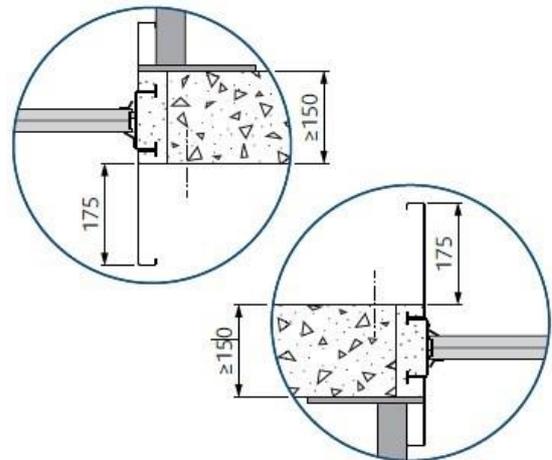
(EI120S) Sezione trasversale di ① Installazione umida in soletta/pavimento rigidi
